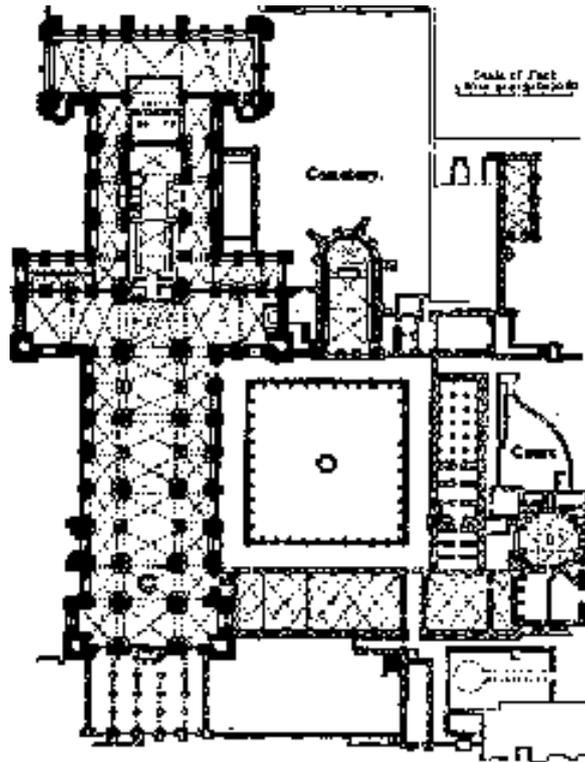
Planta baixa da igreja de Durham, na Inglaterra.
